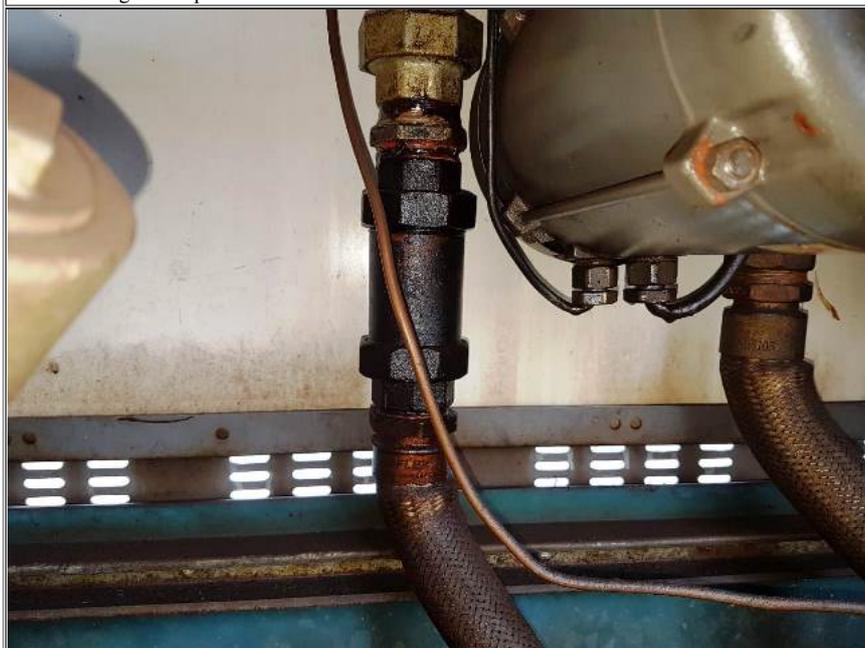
checkvalve - com exsudação demonstrando vazamento
